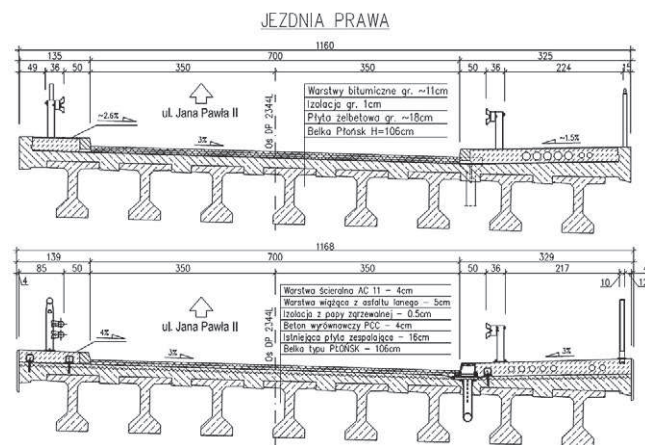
Przekrój podłużny wiaduktu przed remontem – wiadukt prawy. Źródło: Protechnicon [8]
